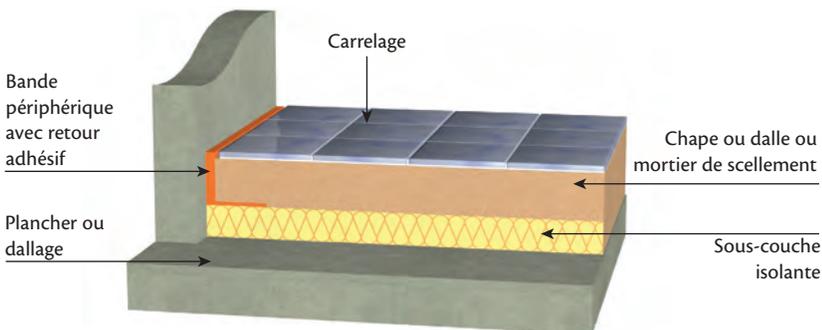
Mise en place d'une bande périphérique avec retour adhésif
